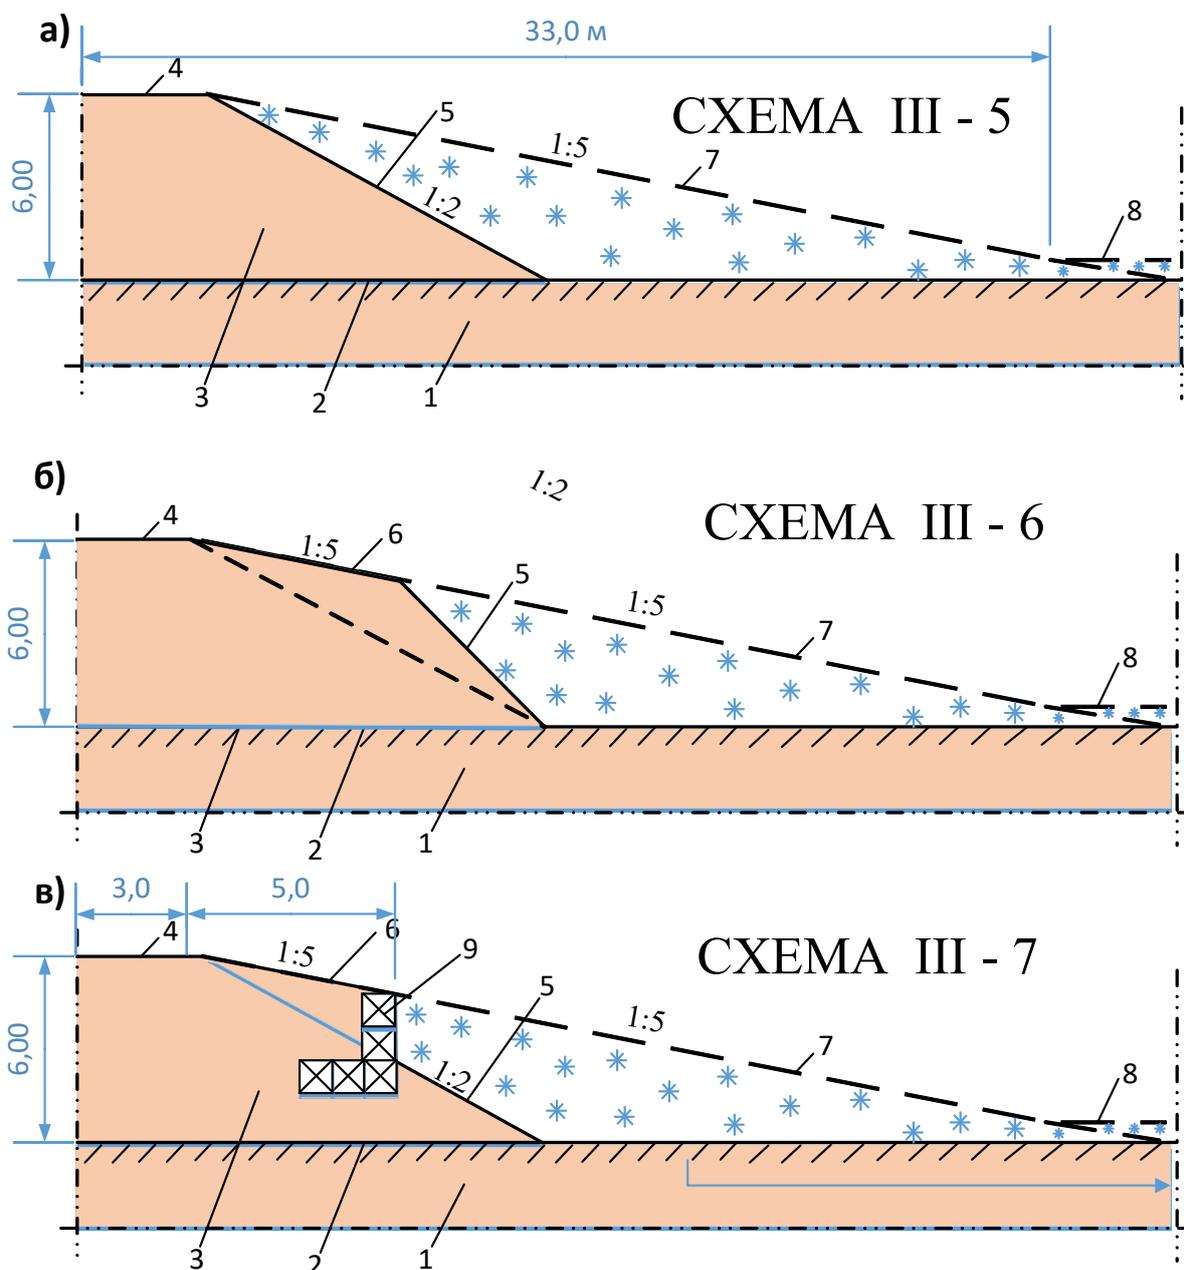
Принципиальные схемы отдельной охлаждающей площадки насыпи (БОН): а – без применения БОН, б – создание БОН путём перелома поверхности откоса, в - создание БОН путём применения стенки из габионов; 1 – грунты основания, 2 – естественная поверхность грунта, 3 – тело насыпи, 4 – основная площадка, 5 – откос насыпи, 6 – БОН, 7,8 – поверхность снежных отложений соответственно в зоне насыпи и на ненарушенной территории, 9 – стенка из габионов
